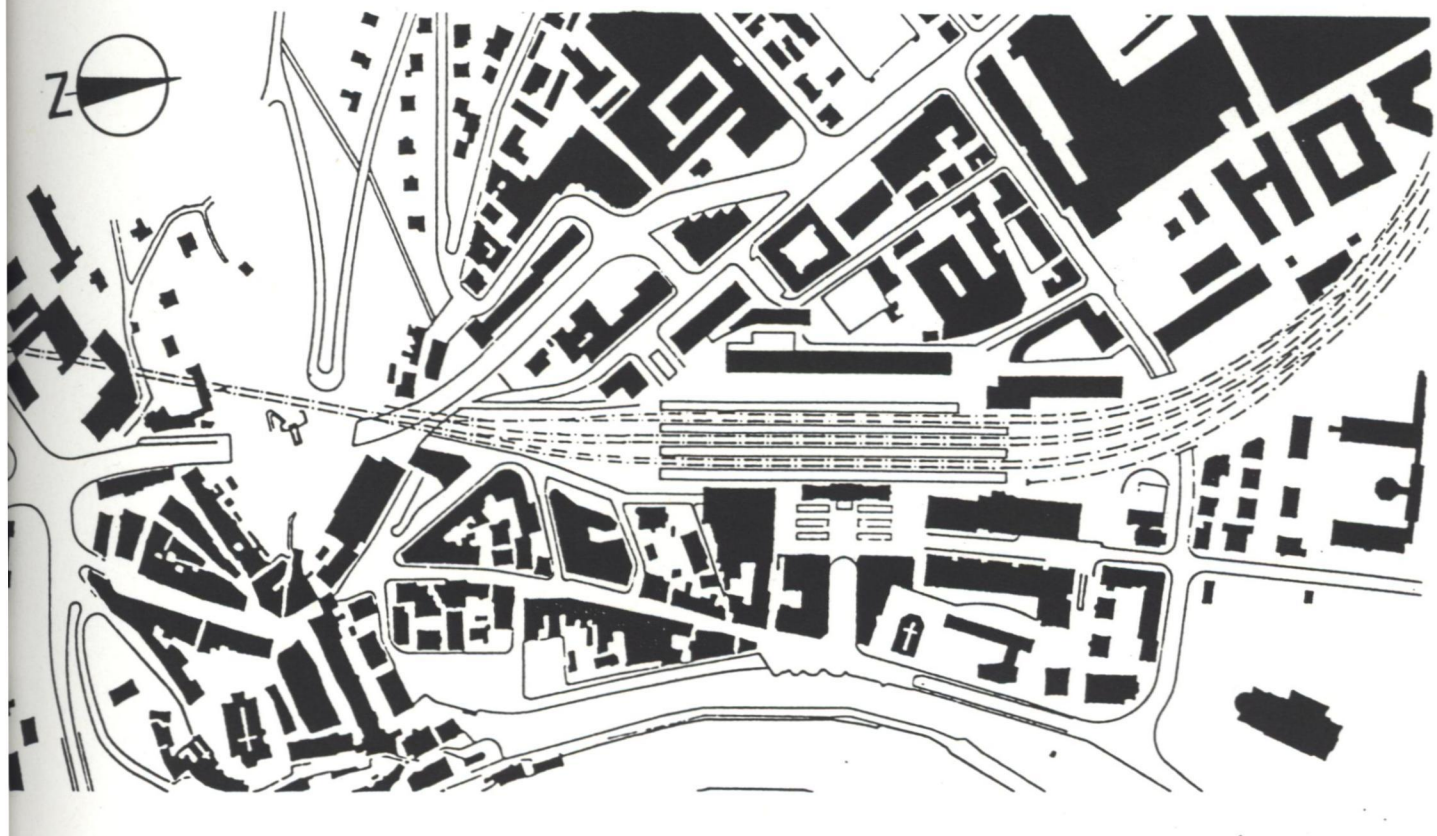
Situationsplan 1:5000 mit Überbauung gemäss Gestaltungsplan
